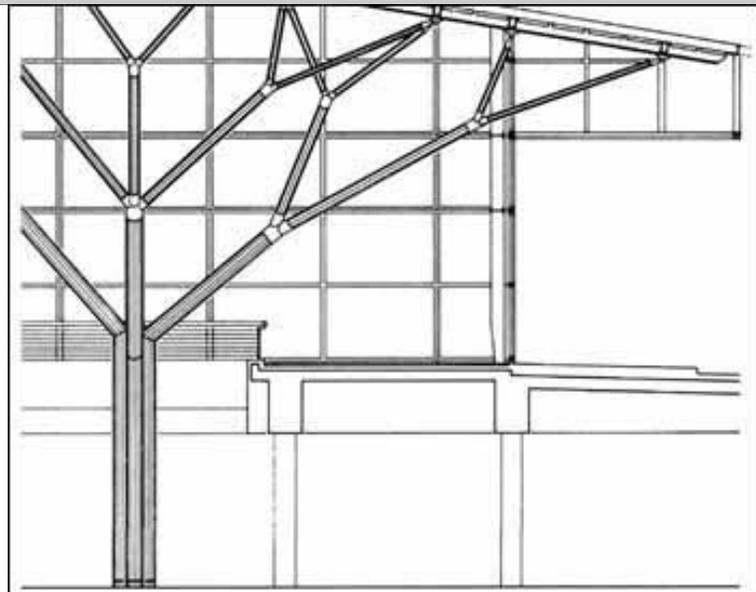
Estructura de acero del Aeropuerto de Stuttgart. Fuente:
